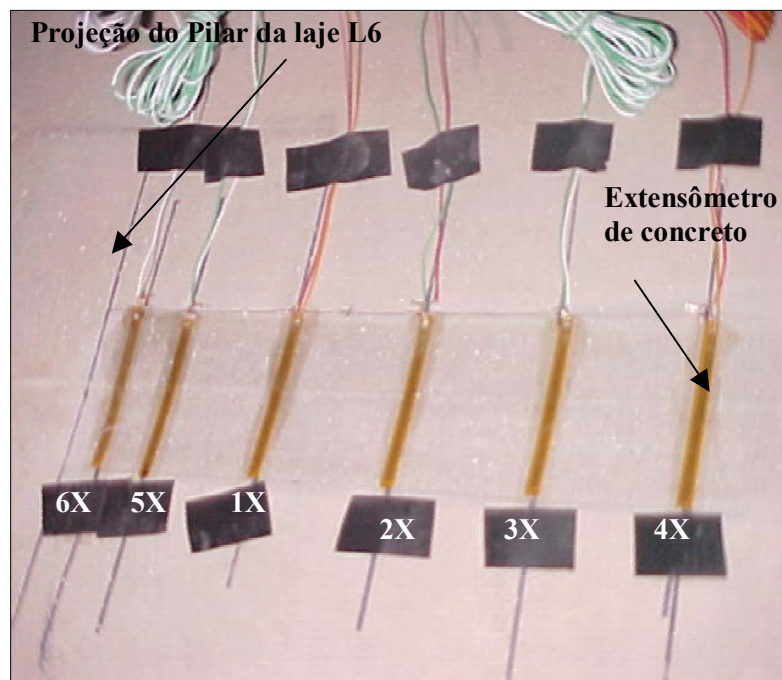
Fotografia dos extensômetros no concreto da laje L6
